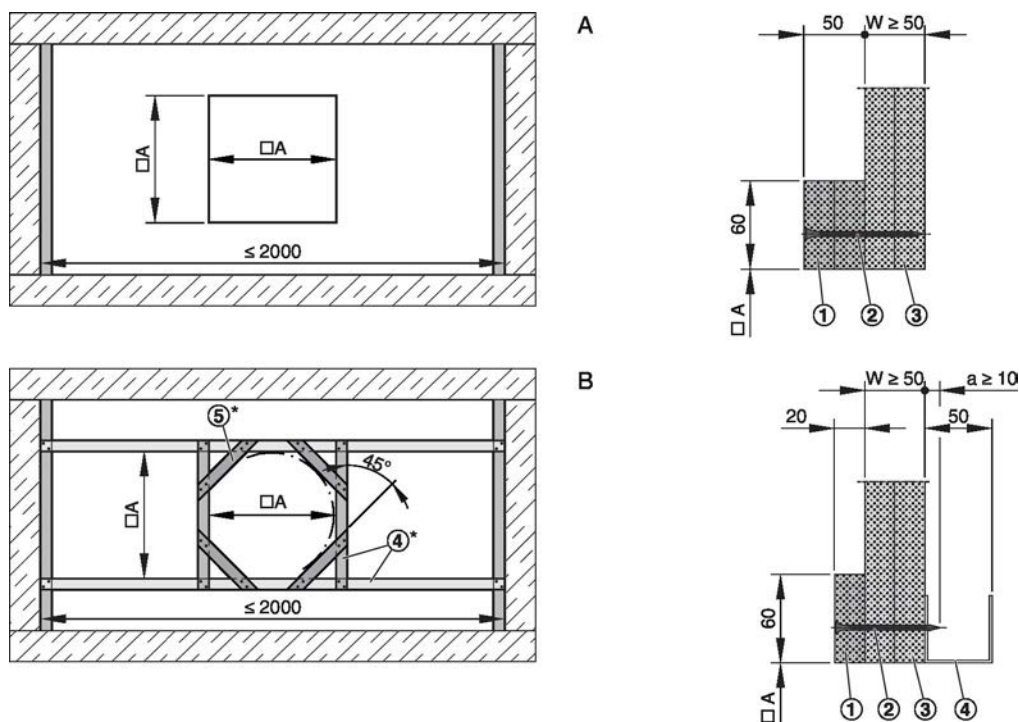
Patinillo sin estructura de pared metálica y aislamiento en un lado
